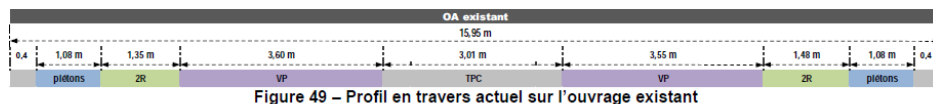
Profil en travers actuel sur l'ouvrage existant
